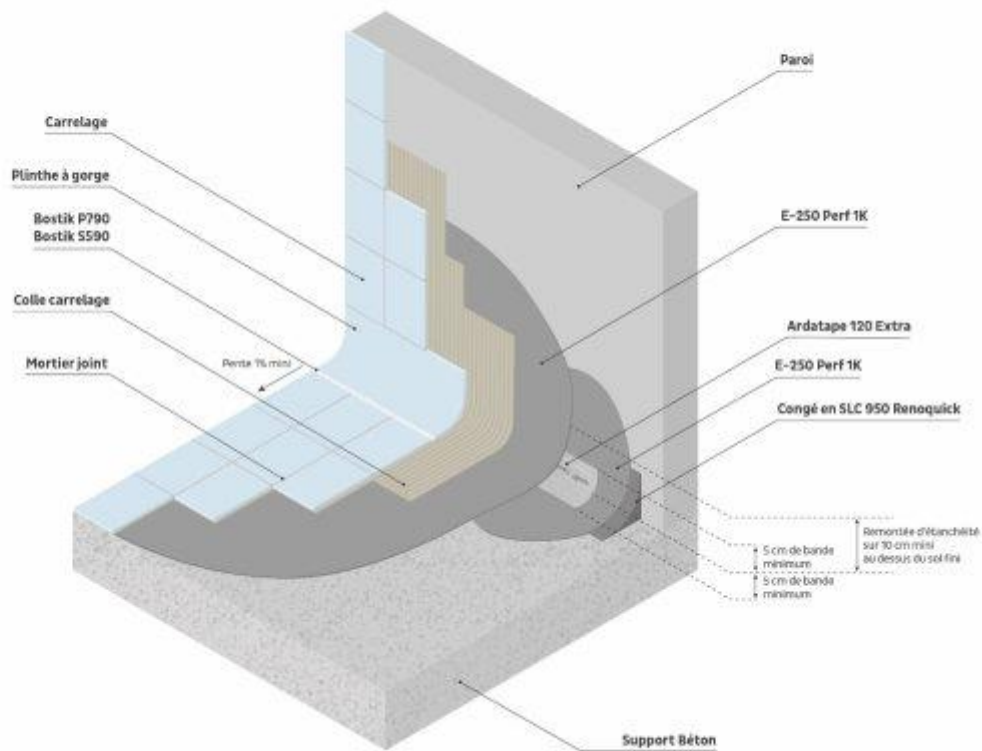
Raccordement Sol / Mur en local P4/P4S
